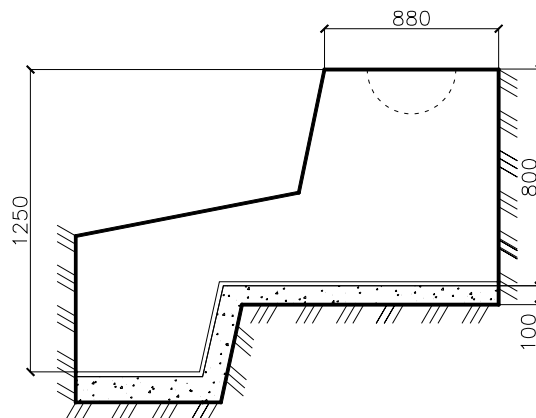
Блочний фундамент з переднім зубом (Миколаївський філіал Укрколгоспроект)
